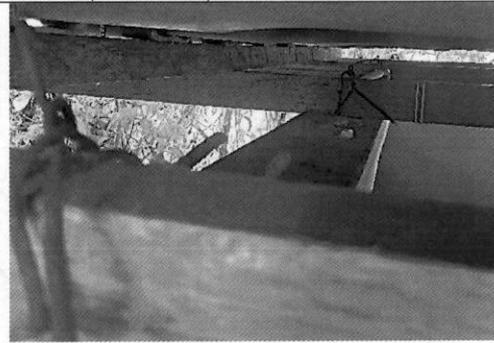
Amarre de vigas de madera de 2"x3" mediante alambre, los cuales se encuentran embebidos en las vigas de concreto de las UBS (no se han colocado tornillos ni platina de hierro).
